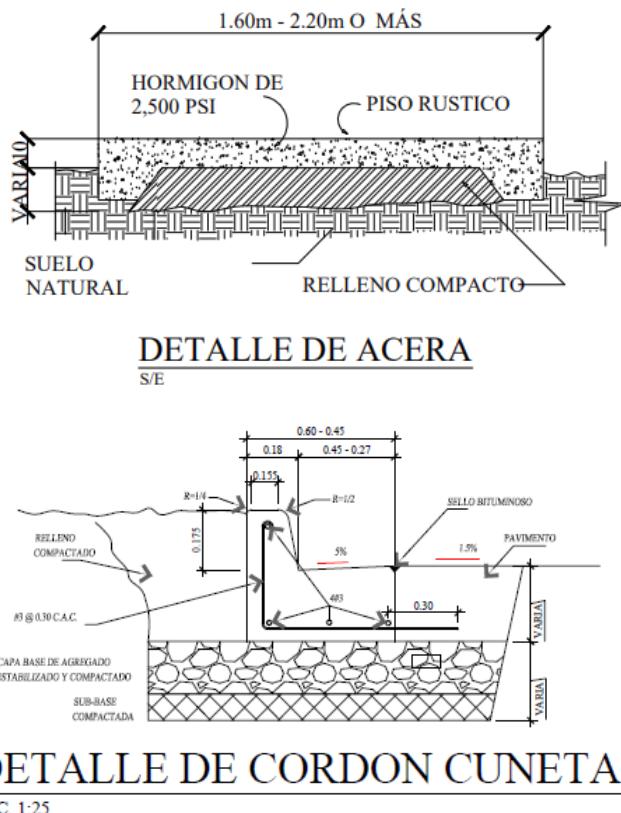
Detalle de calzada peatonal. Fuente: Plano del proyecto.
